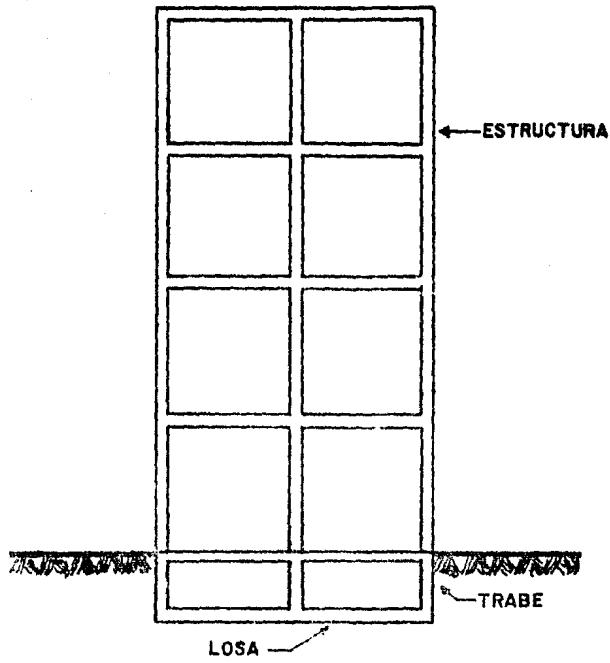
LOSA DE CIMENTACION CON TRABES
